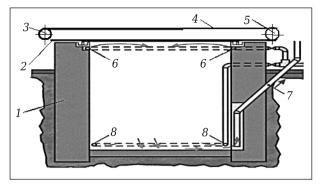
Схема установки гибкого полотна над пропарочной камерой: 1 — пропарочная камера; 2 — гибкое полотно; 3 — приводной барабан для намотки и размотки гибкого полотна; 4 — тяговый элемент; 5 — шкивы; 6 — верхние перфорированные трубы; 7 — отводная труба; 8 — нижние перфорированные трубы
